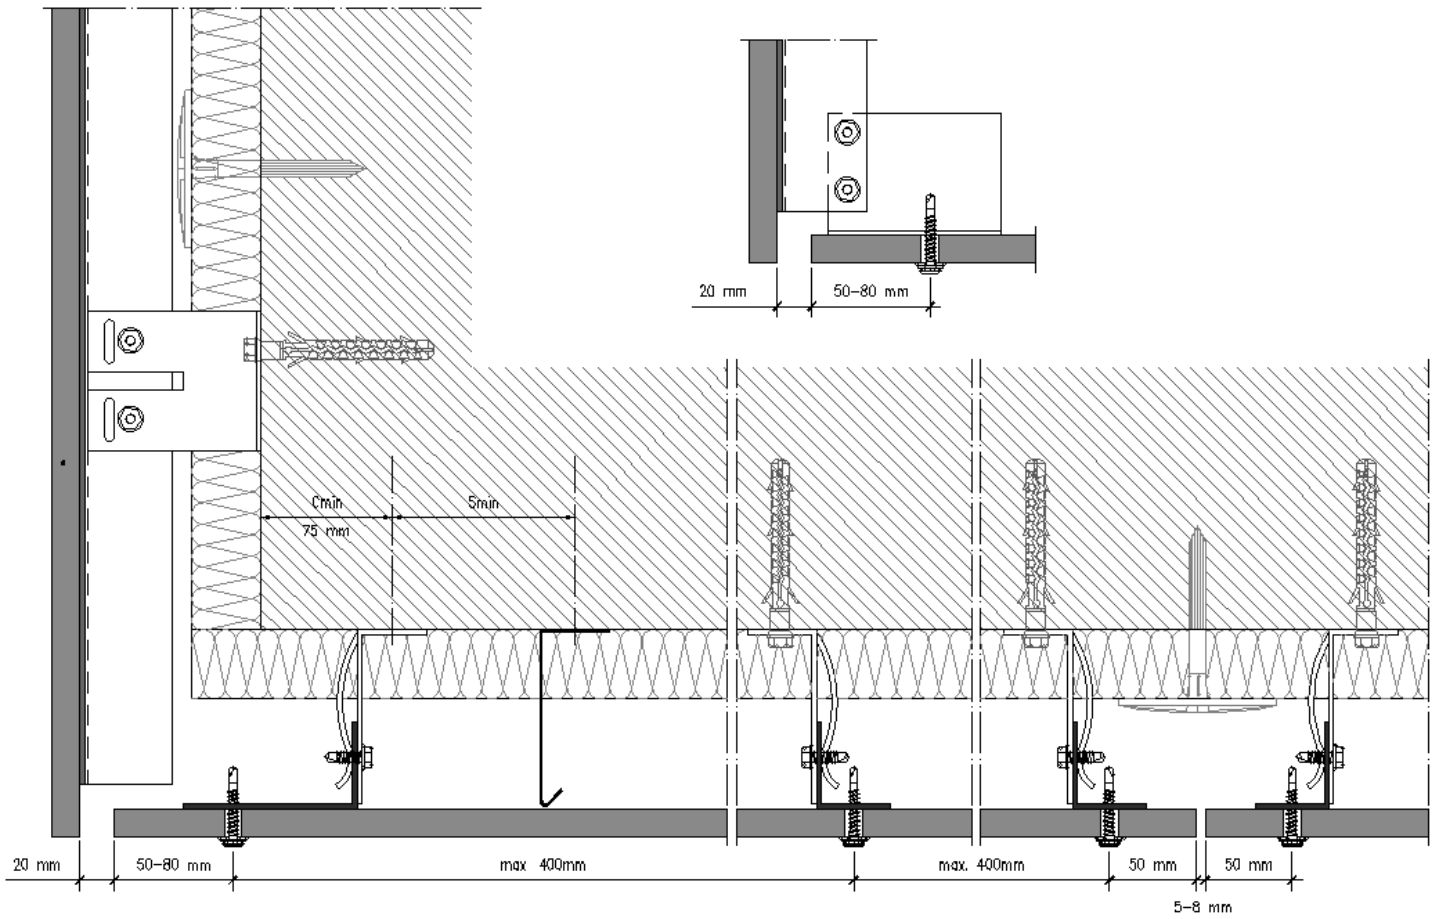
Détail de la pose Façade - Faux-plafonds
